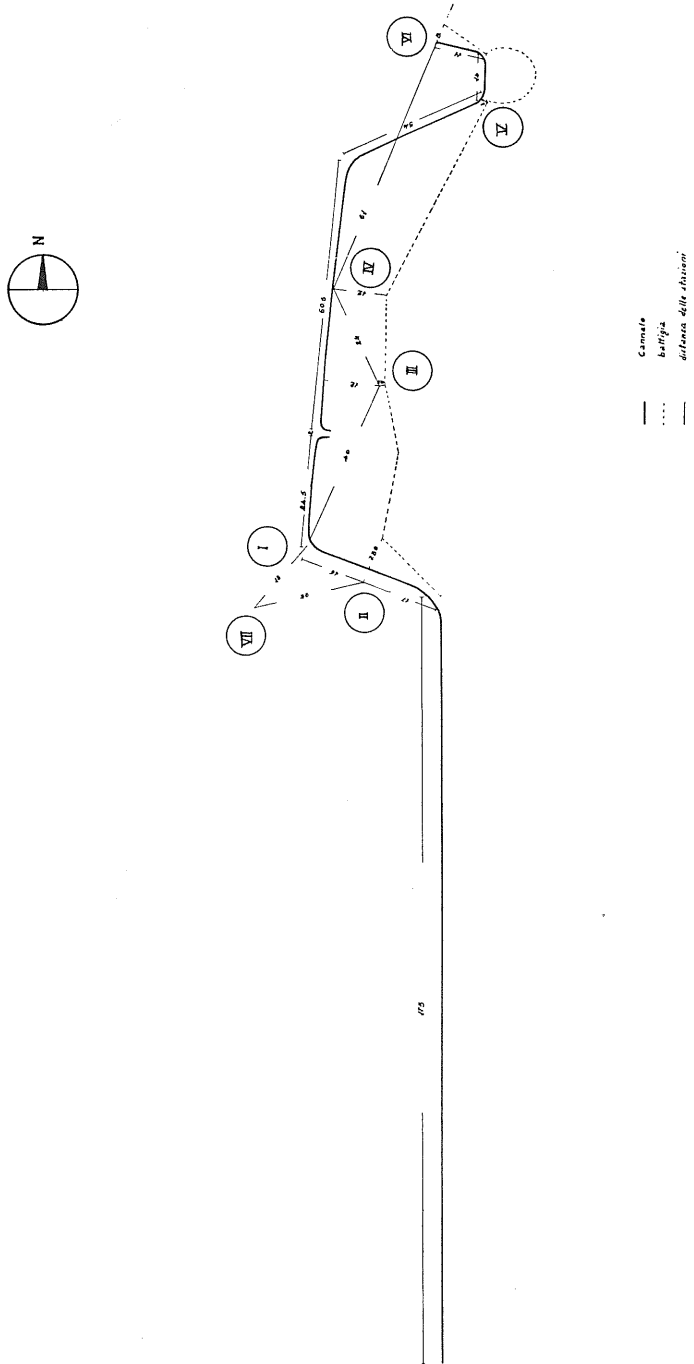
Planimetria del frangiteto indicante l'ubicazione dei fastelli (Monte del Lago, 1956-57).
